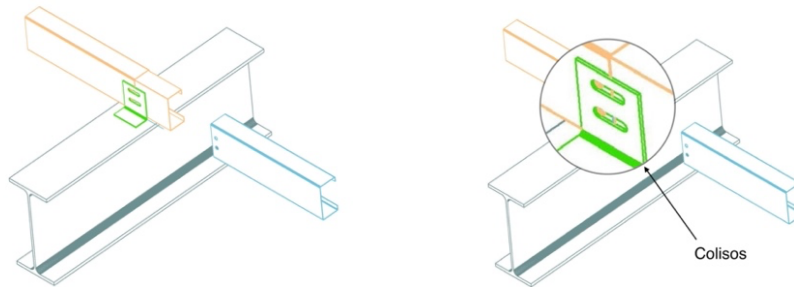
Detalle ejón de anclaje correas en cubierta, zona junta de dilatación. CAD Estructuras.
